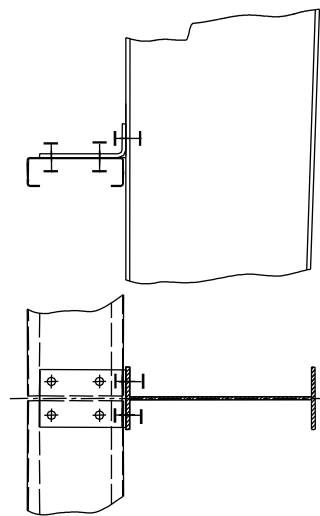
Stěnový plášť z pórobetonových panelů
